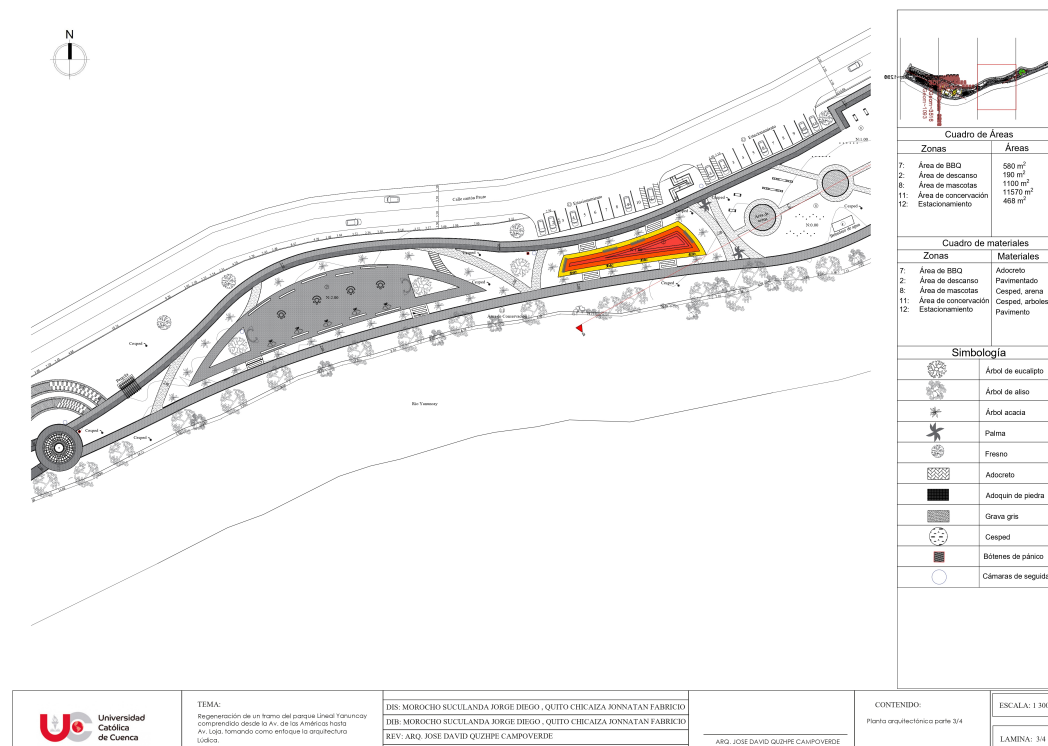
Planta 3 de 4. Fuente : Propia
